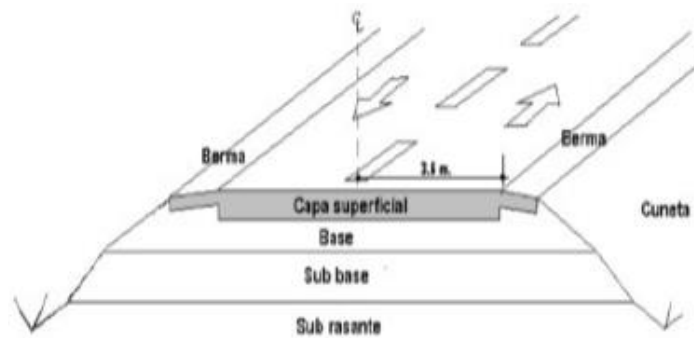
Estructura típica de un pavimento asfáltico (flexible)
